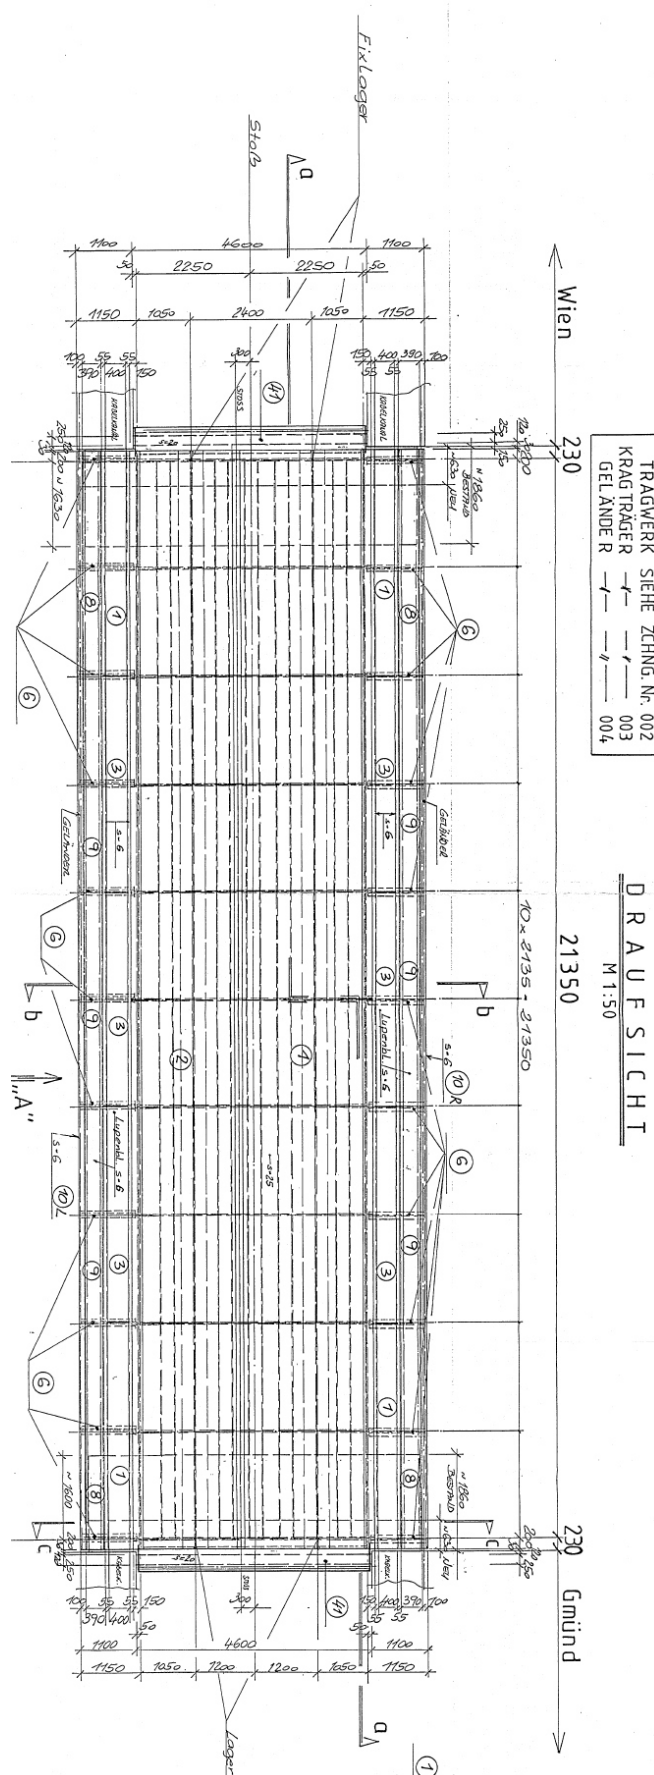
Grundriss Farrenbachviadukt
